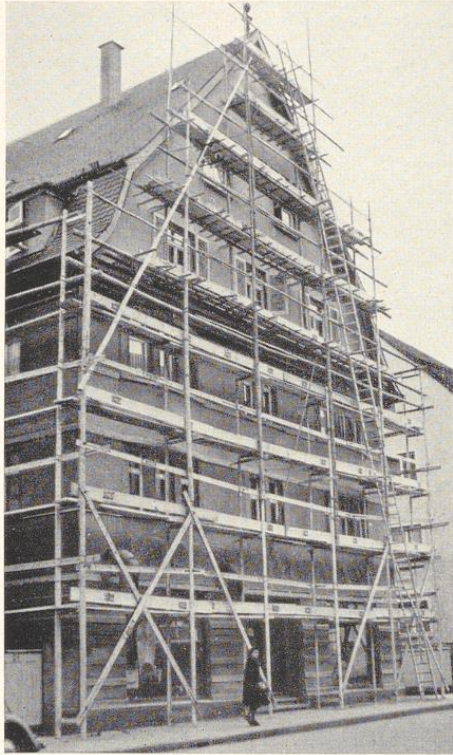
Einfaches Leitergerüst mit Doppelstangengerüst
